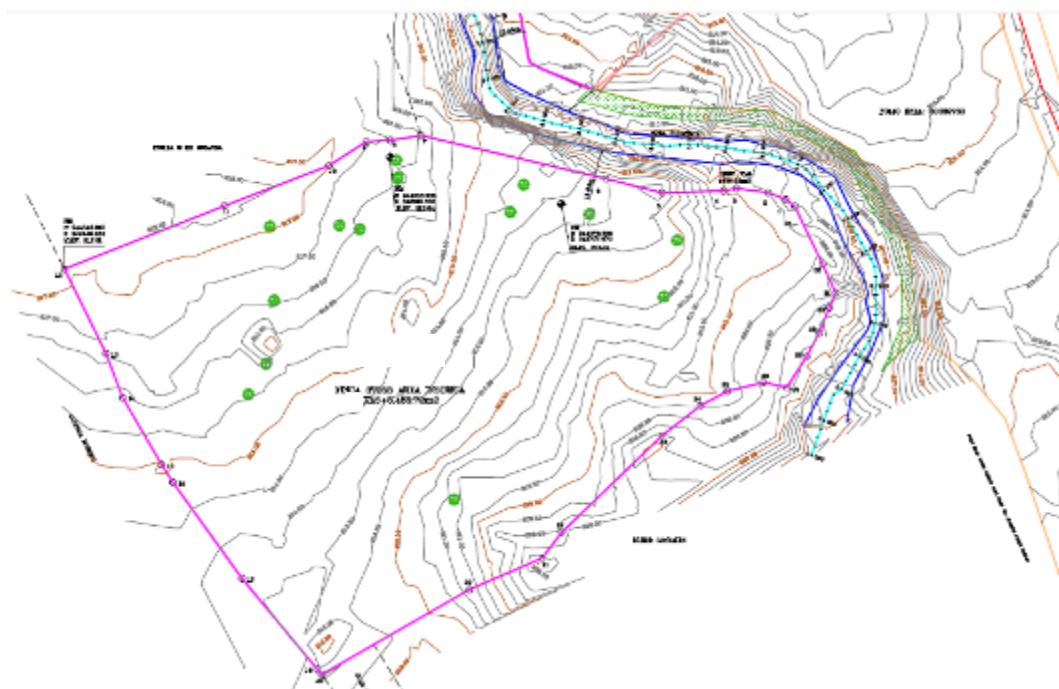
Imagen del plano topográfico del proyecto. Fuente: Planos del Anteproyecto.
